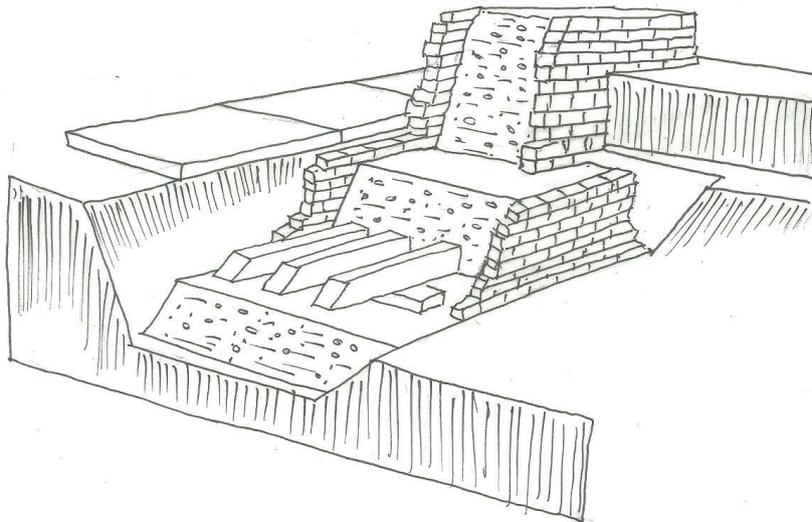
Zapatas sobre emparrillado de Madera en la Catedral de York. S XI. Philips, Derek (1984) Excavations at the York Minster-The Cathedral of Archbishop Thomas of Boyeux, II. Londres.
